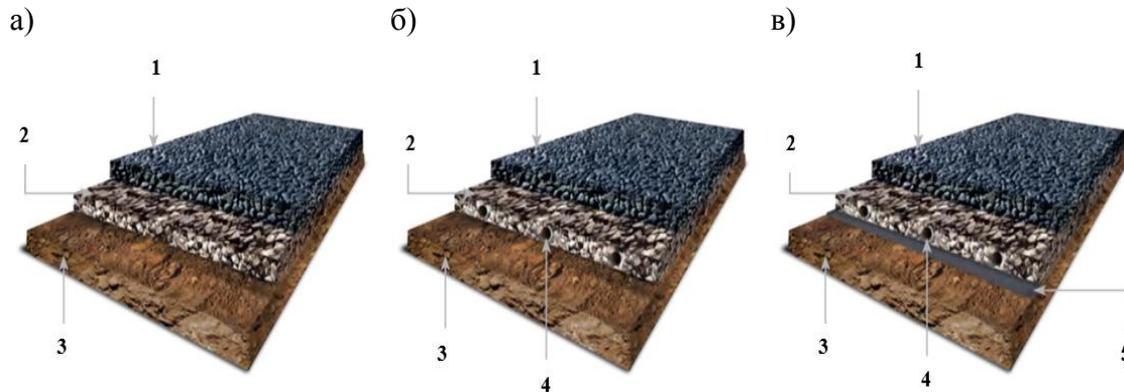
Виды конструкции сплошного покрытия из водопроницаемого бетона [31]:
